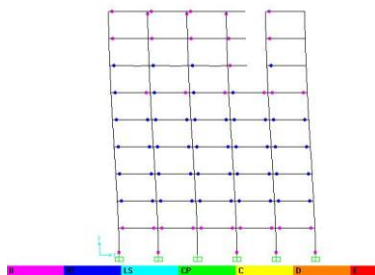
SRBE lantai 7 arah X step 4 (Sumber Permodelan Sap2000)
